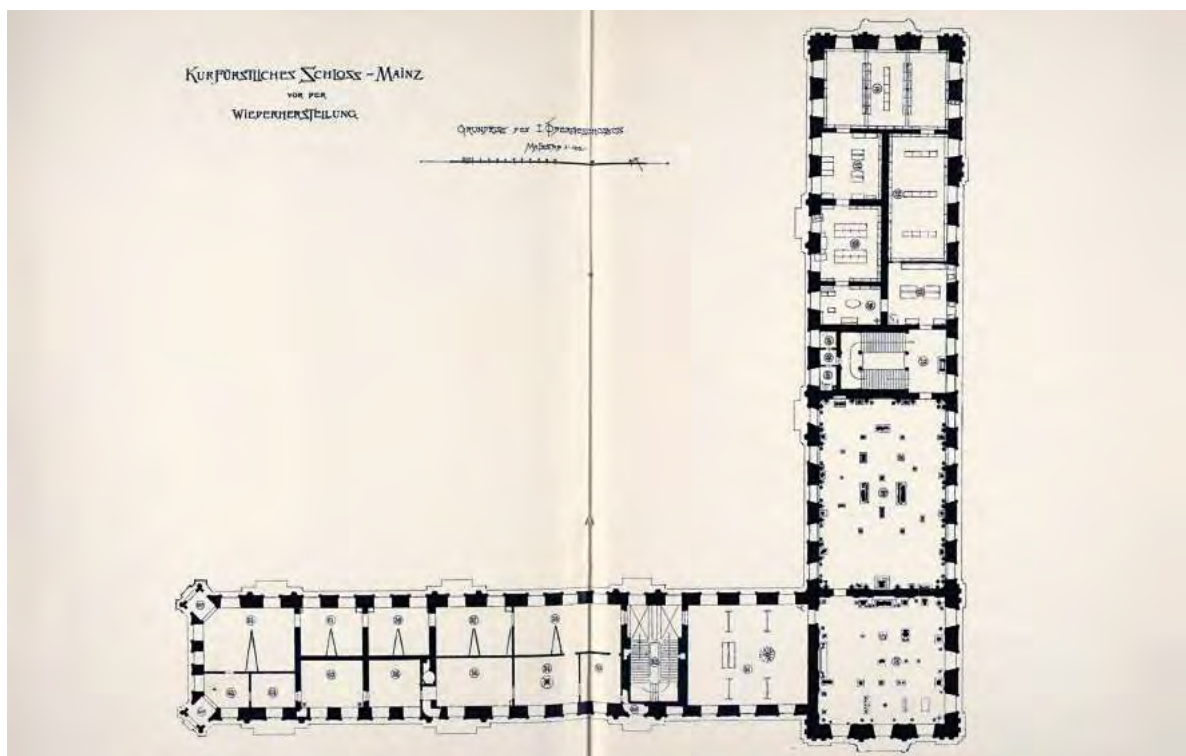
b Grundriss des 1. Obergeschosses vor der Instandsetzung.
